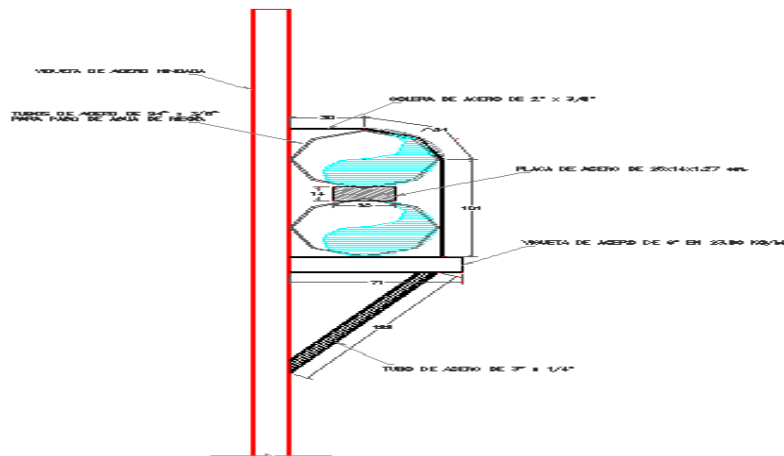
Soporte de la tubería de acero en zona de viguetas (alzado)
